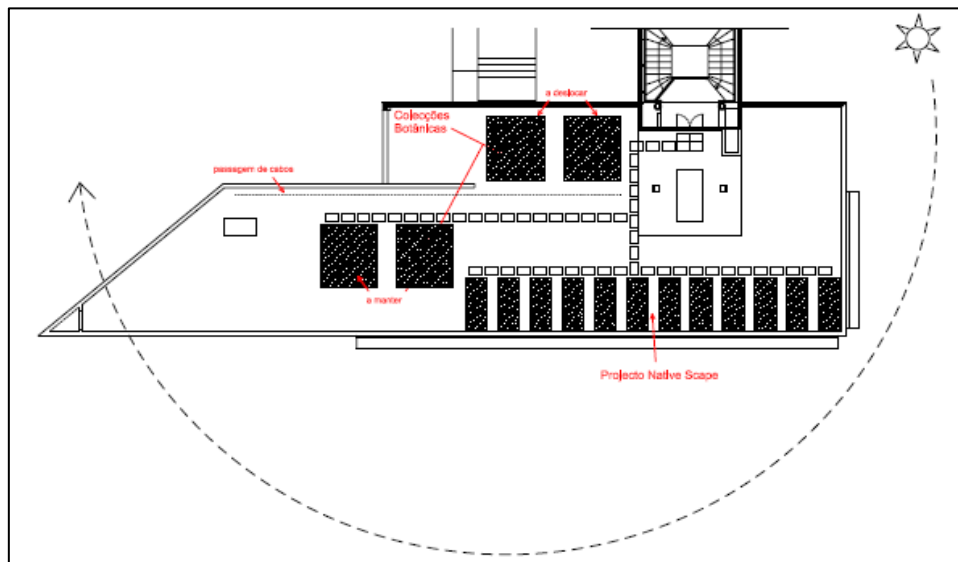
Plano do dispositivo experimental 2 (Fonte: [A] AINDA ARQUITECTURA)
